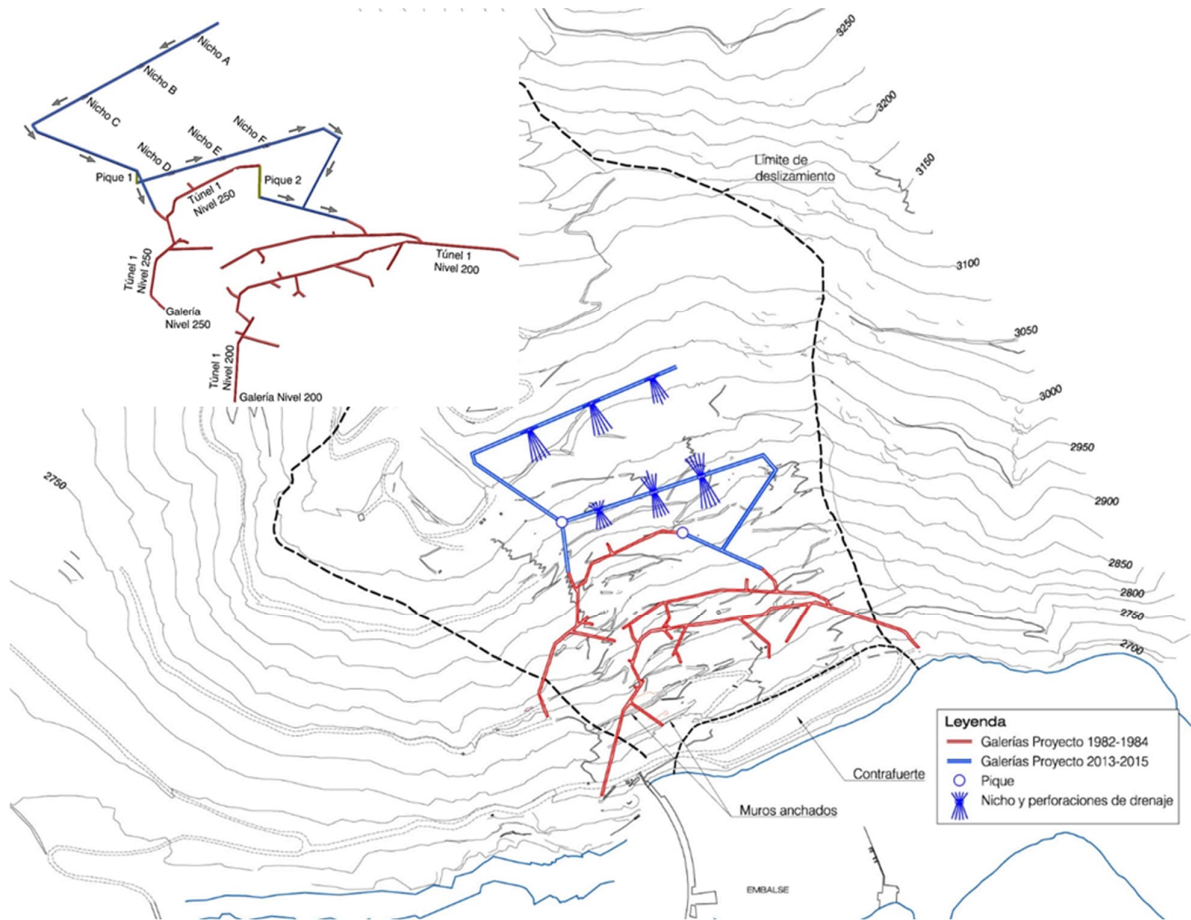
Planta general de las galerías de drenaje proyectadas y vista representativa de las galerías antiguas y galerías nuevas. El trazado rojo corresponde a las galerías antiguas, el azul corresponde a las galerías nuevas del proyecto y la verde a los piques verticales de comunicación y ventilación
